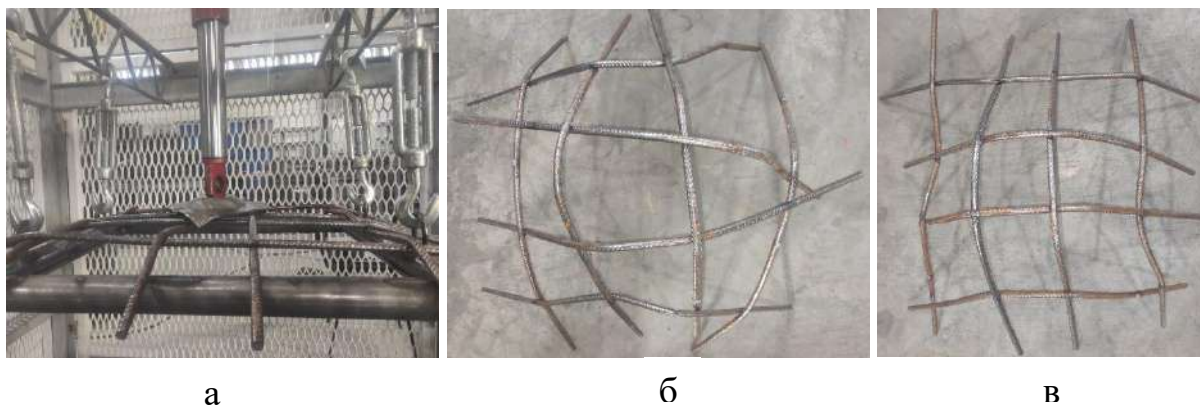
Испытание армокаркасов: а – общий вид стенда; б – вид армокаркаса без сварки в точках пересечения в центральной зоне; в – вид армокаркас со сваркой во всех точках пересечения
